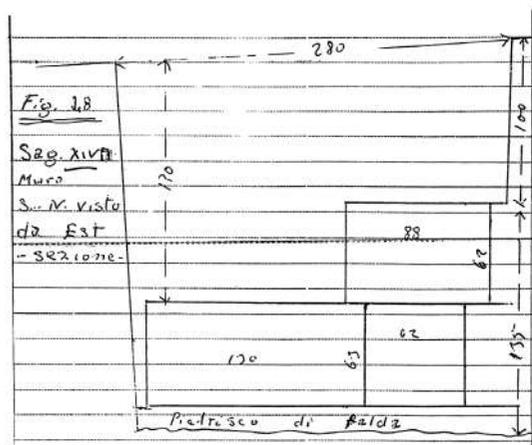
Sag. XIV, Muro S-N visto da Est - sezione -
